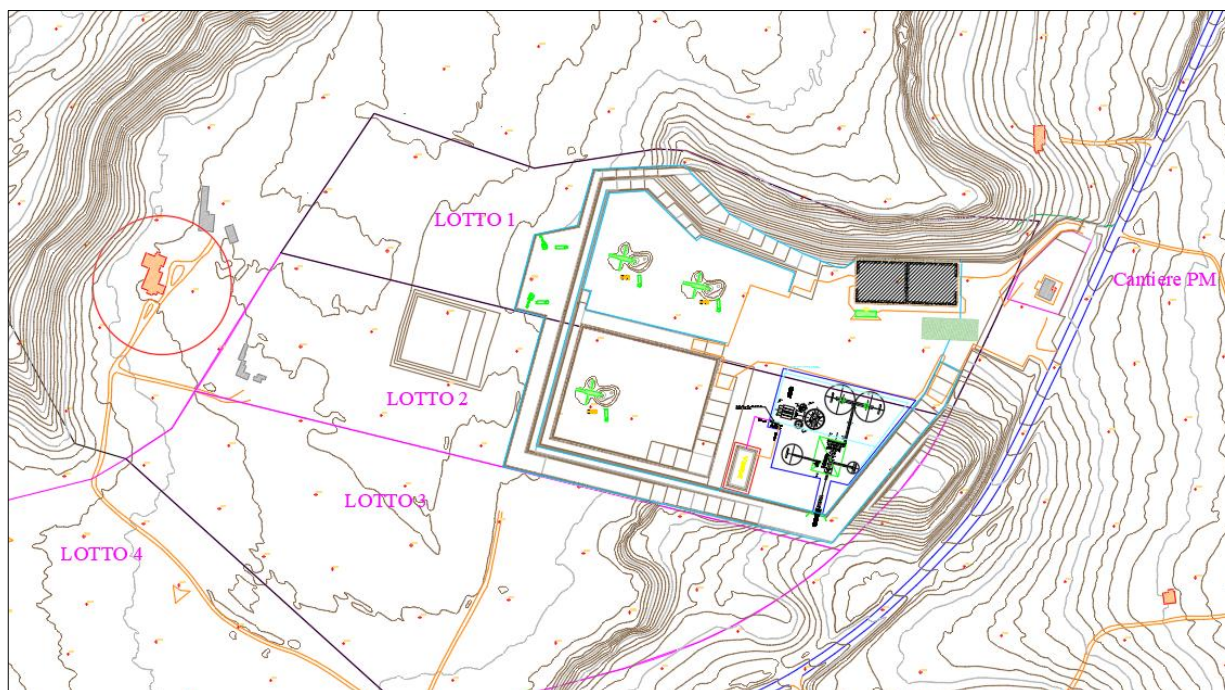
/C: Pianta di Progetto con ubicazione delle opere da realizzare
